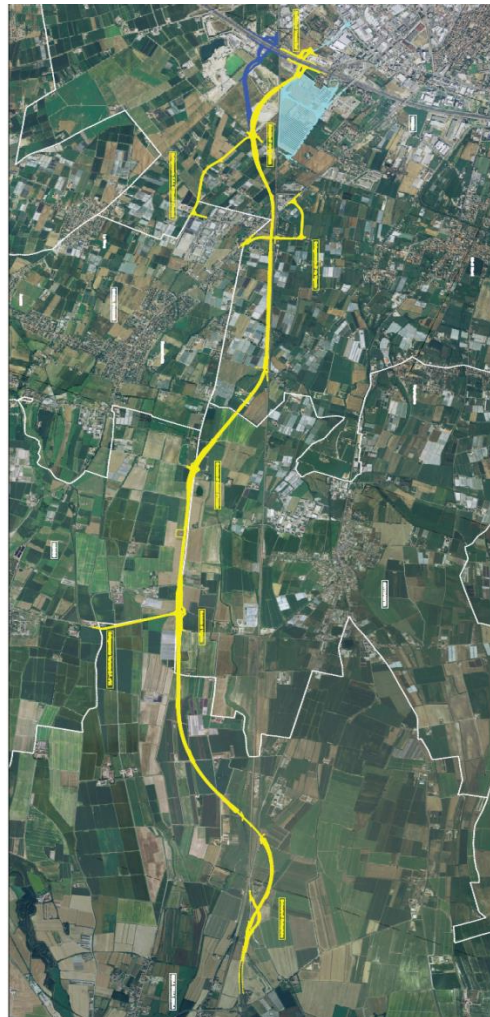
Progetto Anas 2014 –Alternativa 1
